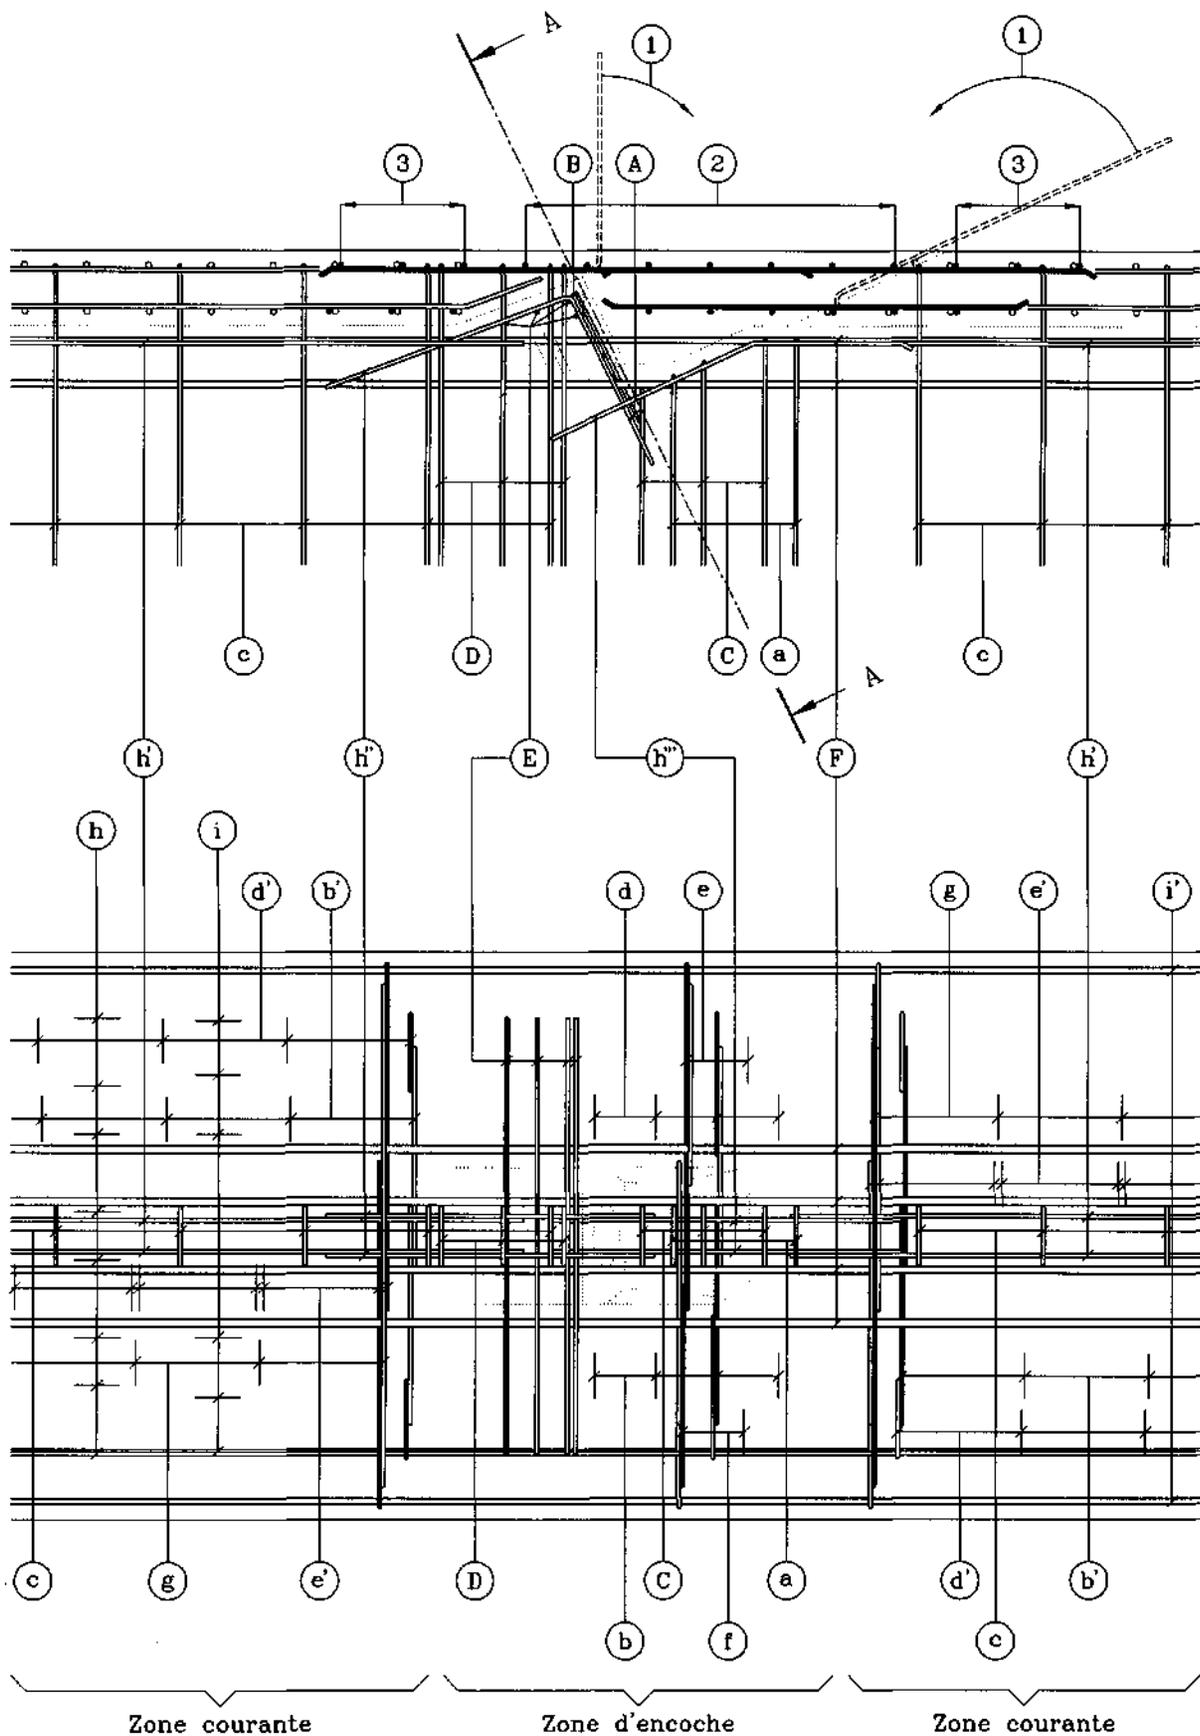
Coupe longitudinale et vue en plan au droit d'une encoche
